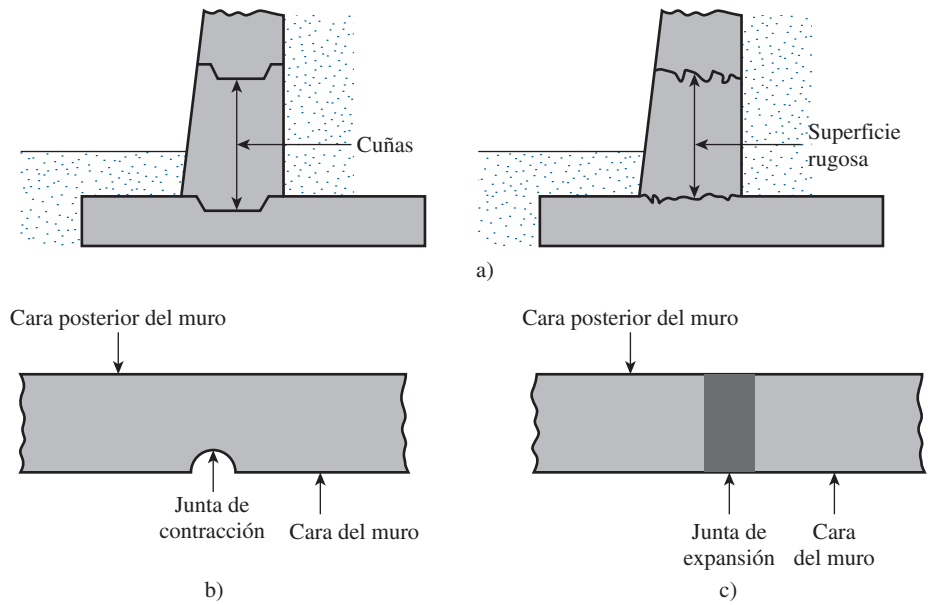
a) Juntas de construcción; b) junta de contracción; c) junta de expansión.
